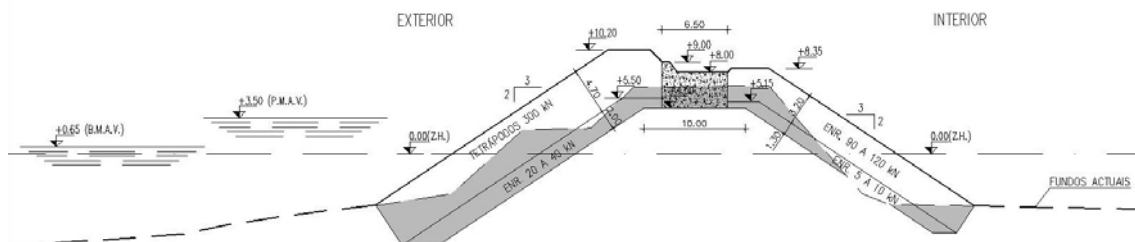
Perfil transversal-tipo do troço a reconstruir
